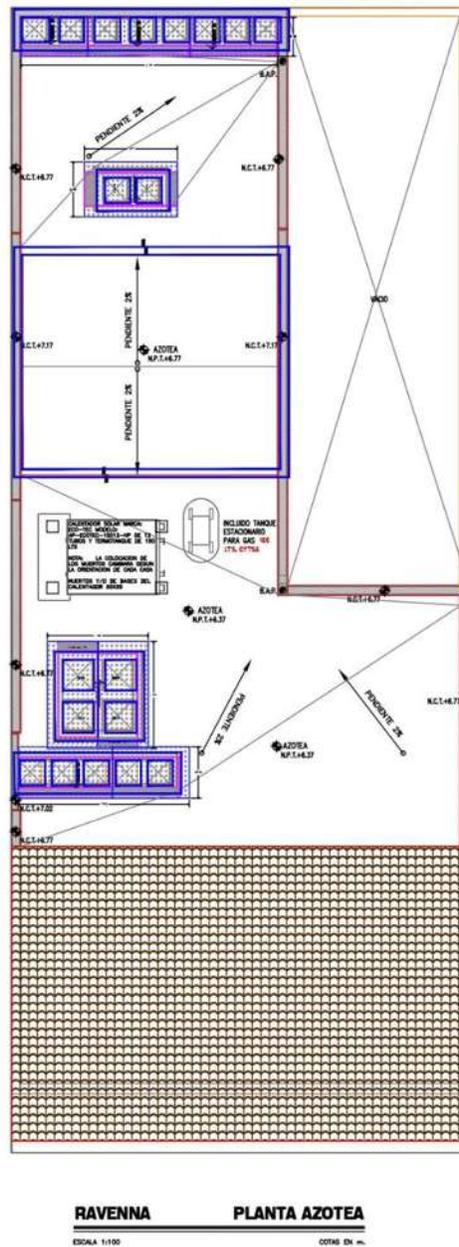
Delimitación de la superficie construida en planta de azotea en prototipo “Ravenna”.
